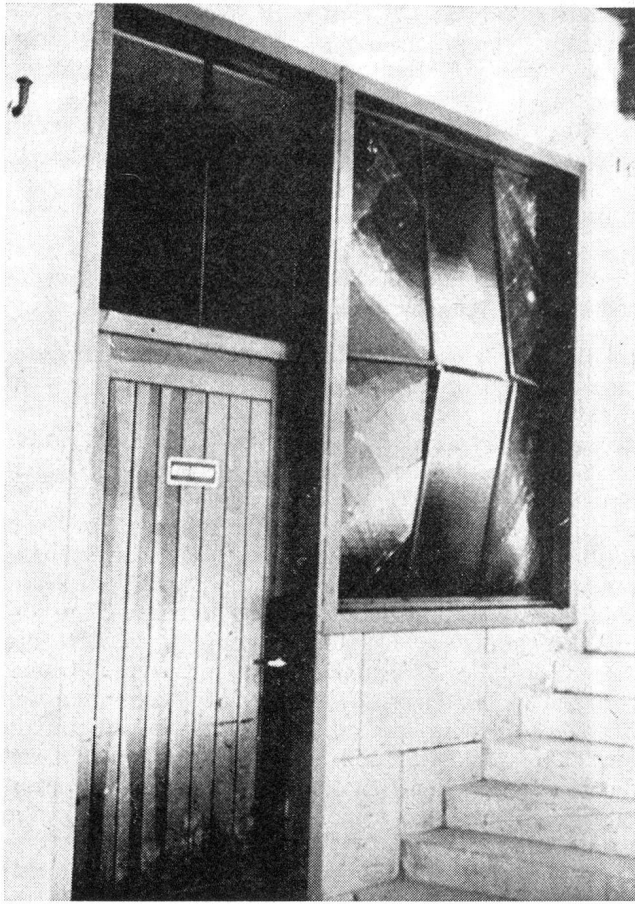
Ein in Richtung gegen die Explosionsstelle gebogenes Drahtglasfenster, das durch einen gefangenen Druckstoss herausgedrückt wurde
